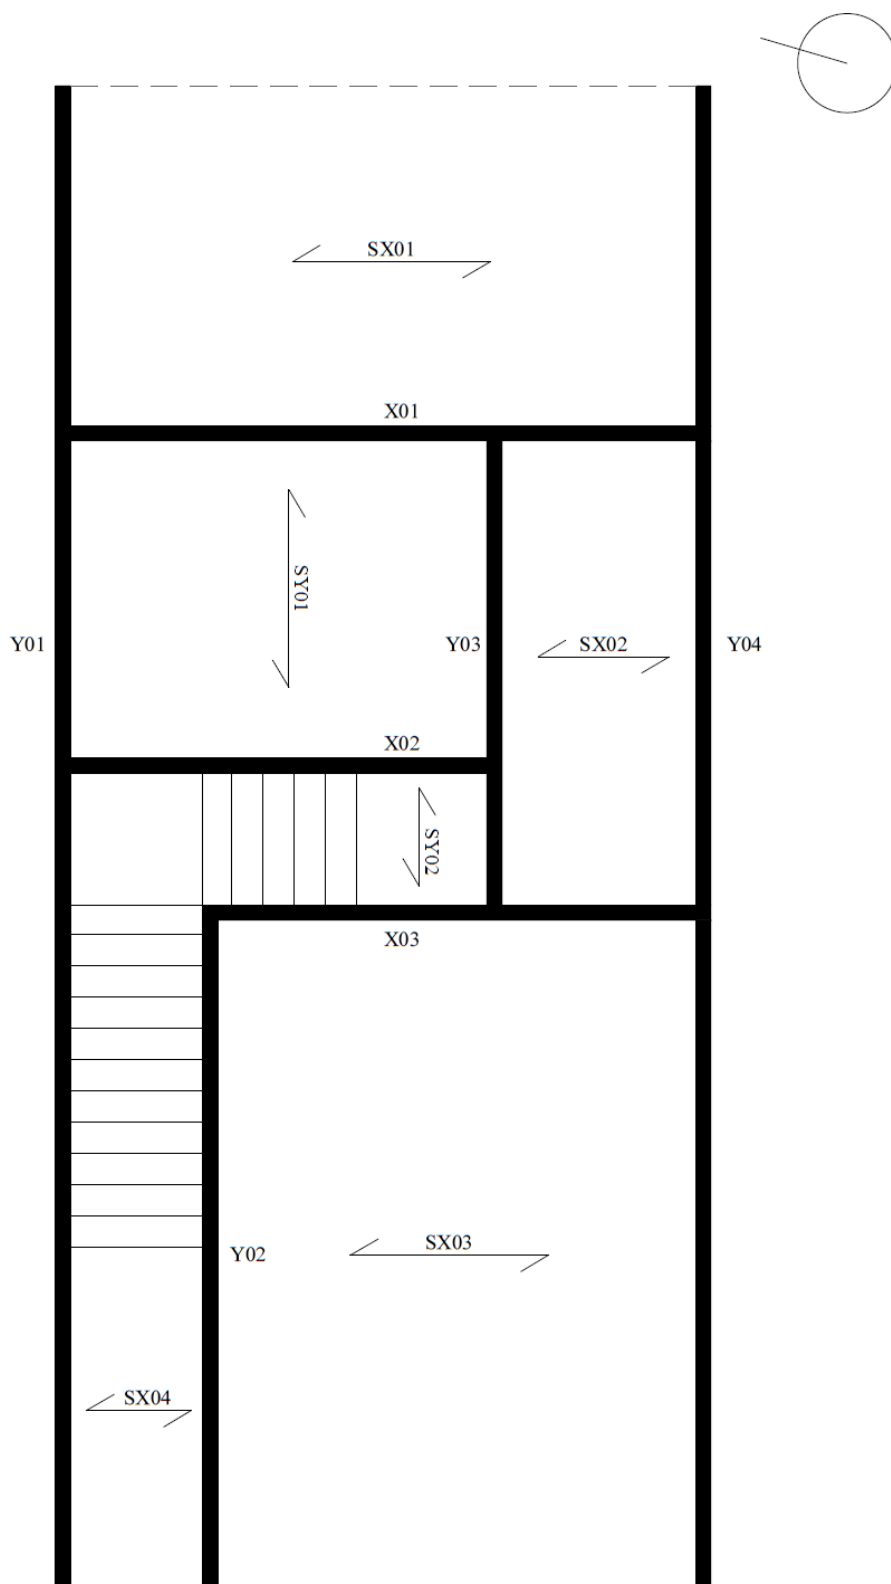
Pianta strutturale 2D rappresentante gli elementi strutturali portanti, su Autocad (elaborazione a cura dell'autrice)
